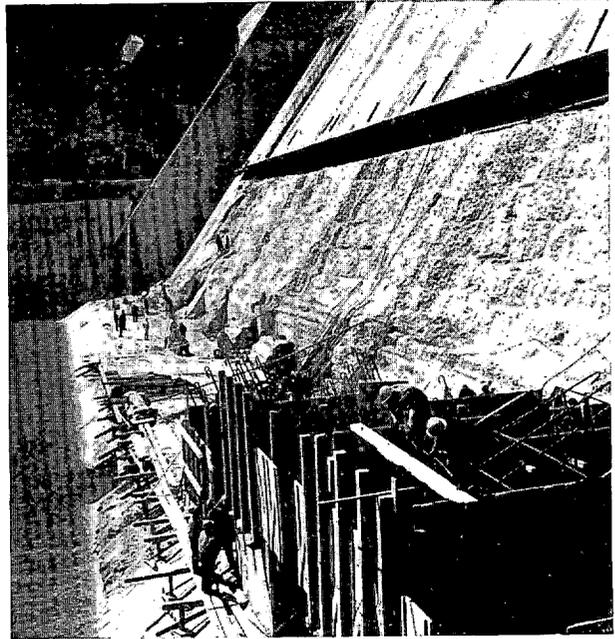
ª — Presa de Mequinzenza, abril 1966. Detalle de las obras de refuerzo.
